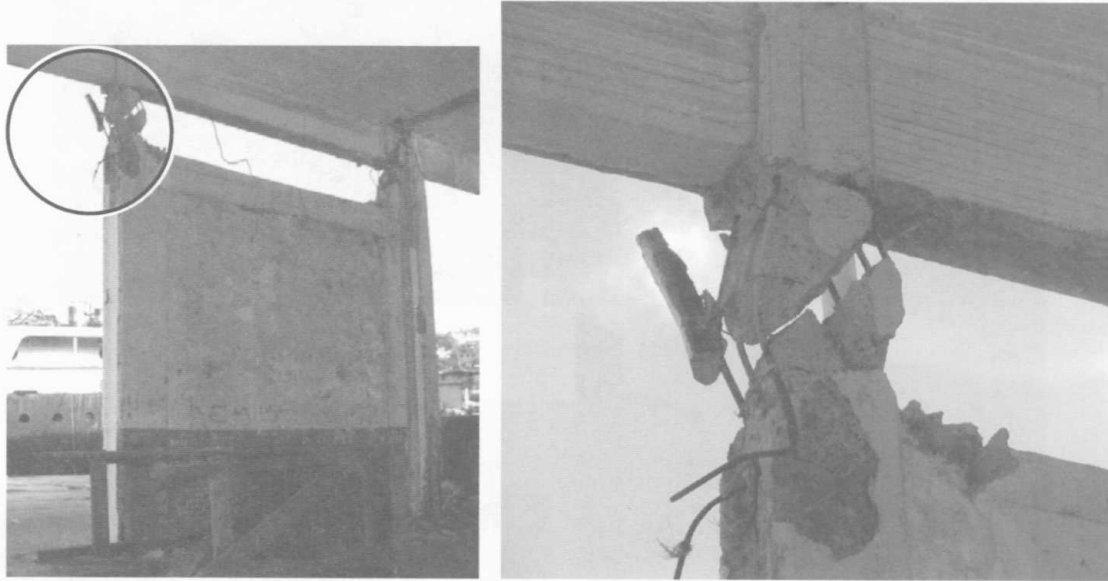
Marco con muro generando la falla de columna corta y detalle
